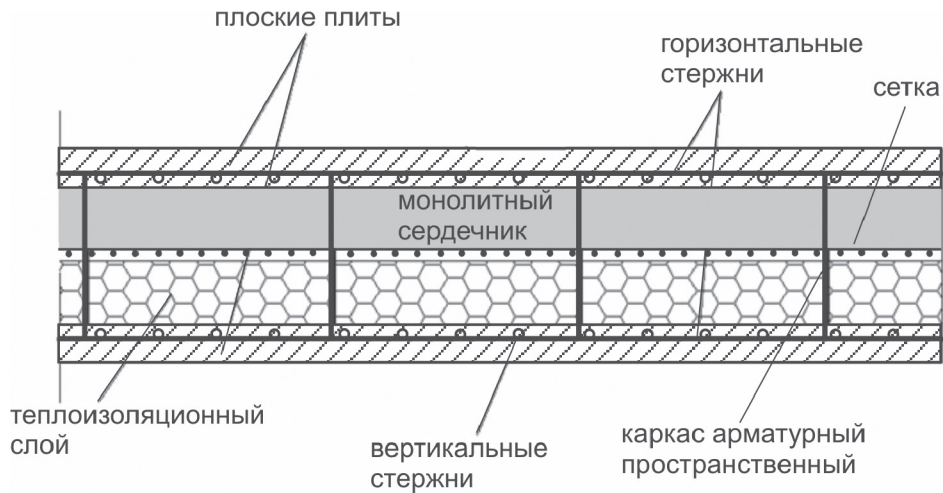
Элемент несъемной опалубки трехслойной наружной стены
